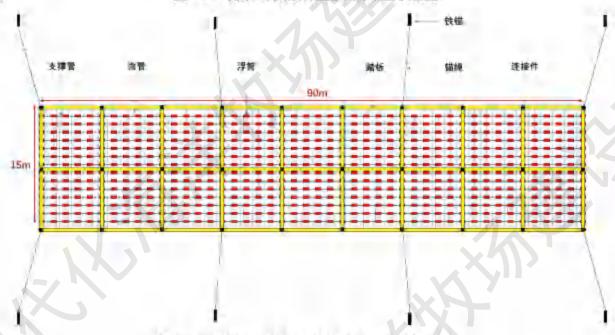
单个栅架式浮筏养殖架平面布置示意图
